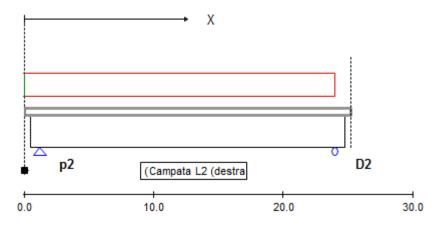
Treno di carico SW2: massimizzazione carico verticale sulla spalla
